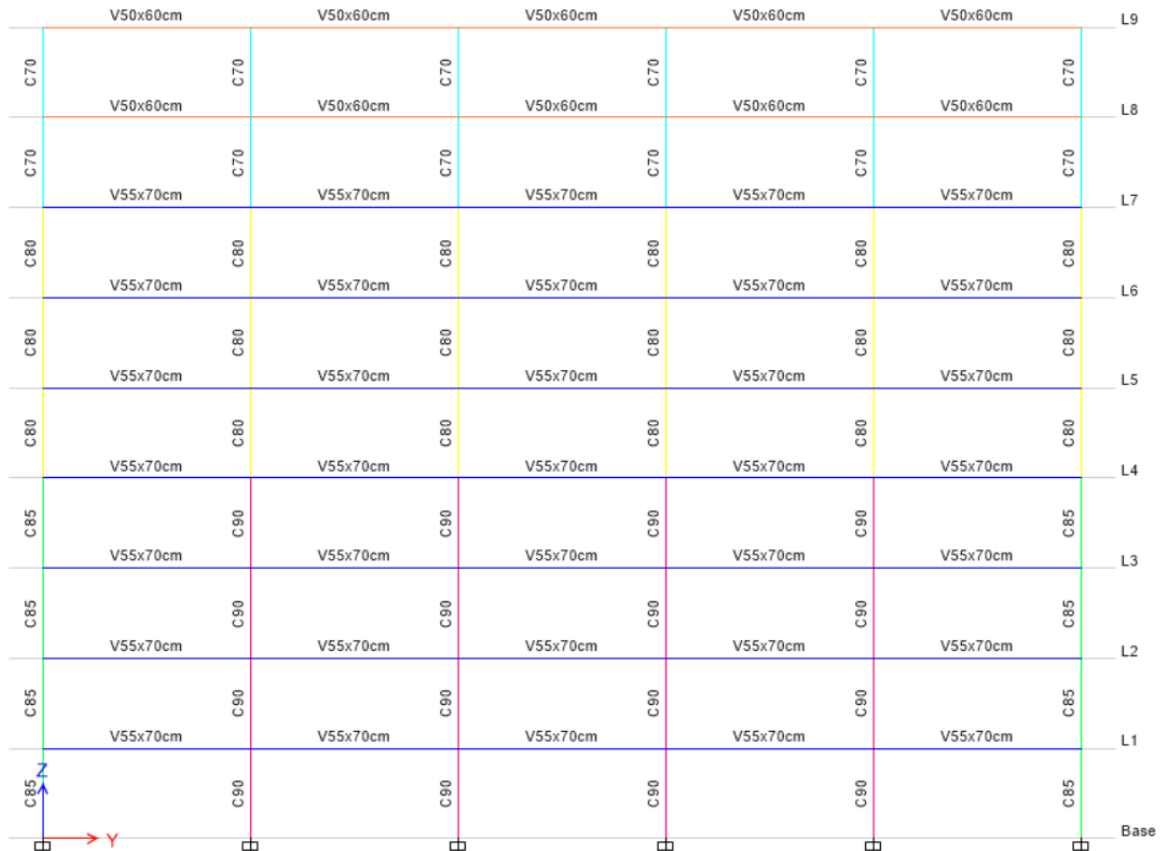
Configuración de un pórtico interior de las secciones para un edificio de 9 pisos para $\Delta_M = 1.0\%$.
